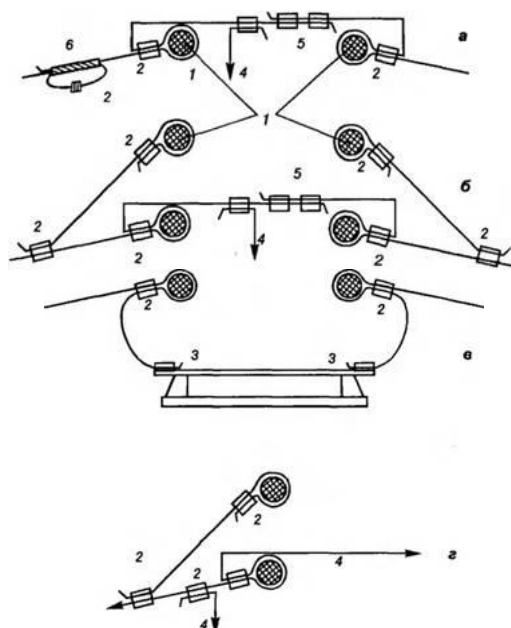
Оптимальные контактные соединения проводов ВЛ 6-10 кВ без их разрыва у изолятора на анкерной опоре: а - одинарное крепление проводов на ответвительной опоре или на опоре с кабельной муфтой наружной установки; б - двойное крепление проводов одной фазы с одновременным ответвлением этой же фазы; в - крепление провода на линейном разъединителе РЛНД-10; ошиновка концевой опоры к кабельной муфте, к вводу в трансформаторную подстанцию и др.; г - двойное крепление провода на концевой опоре с одновременным ответвлением к ТП, к кабельной муфте и др.; 1 - изолятор (показана шейка изолятора); 2 - зажимы марки ПАБ или термосварка, или овальный соединитель; 3 - контактная
